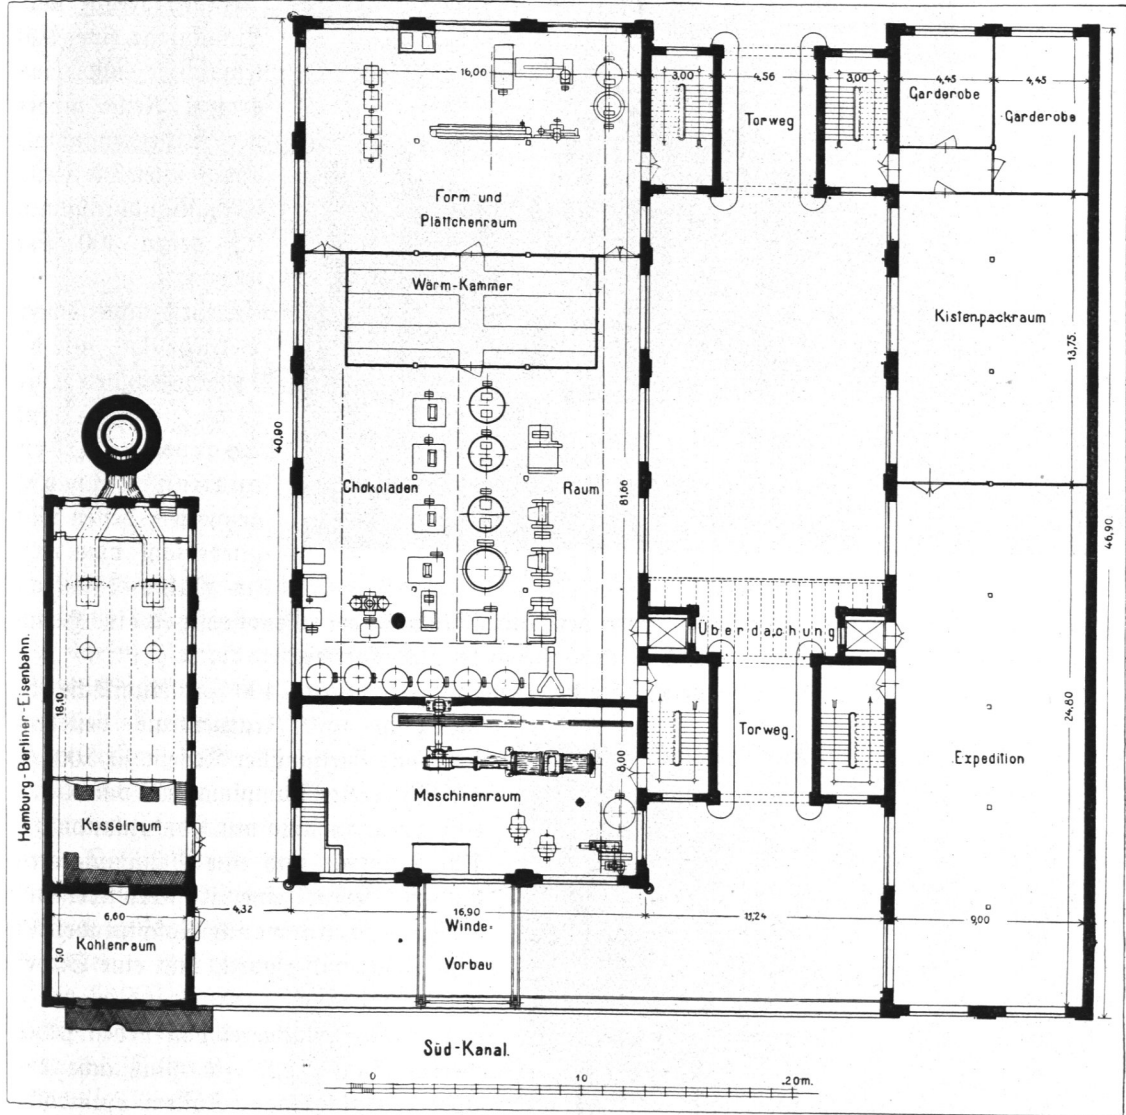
Schokoladenfabrik Reese & Wichmann, Lageplan.
